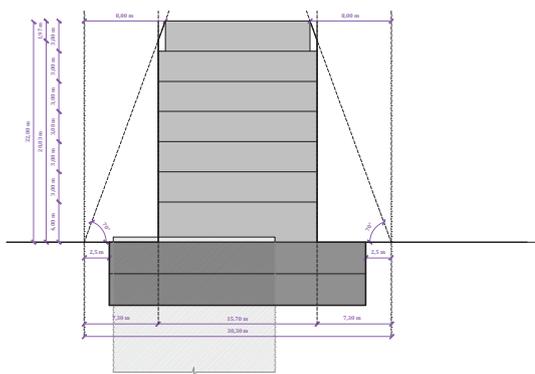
Corte transversal. Esc. 1:750. Fuente: Elab. propia.
